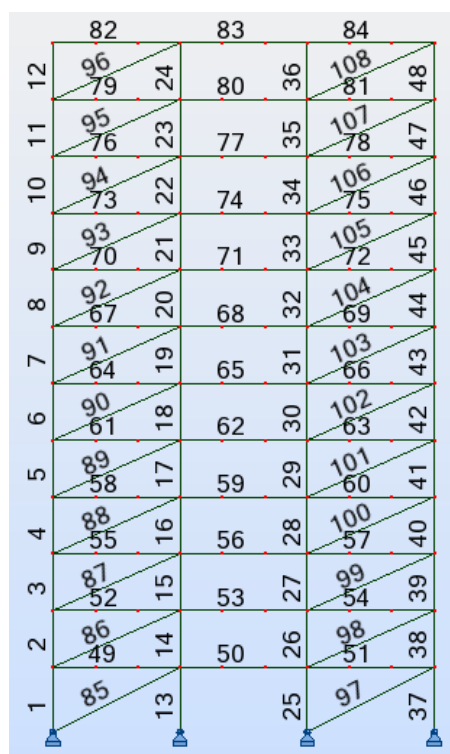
Modelo estrutural do pórtico 12Y2
